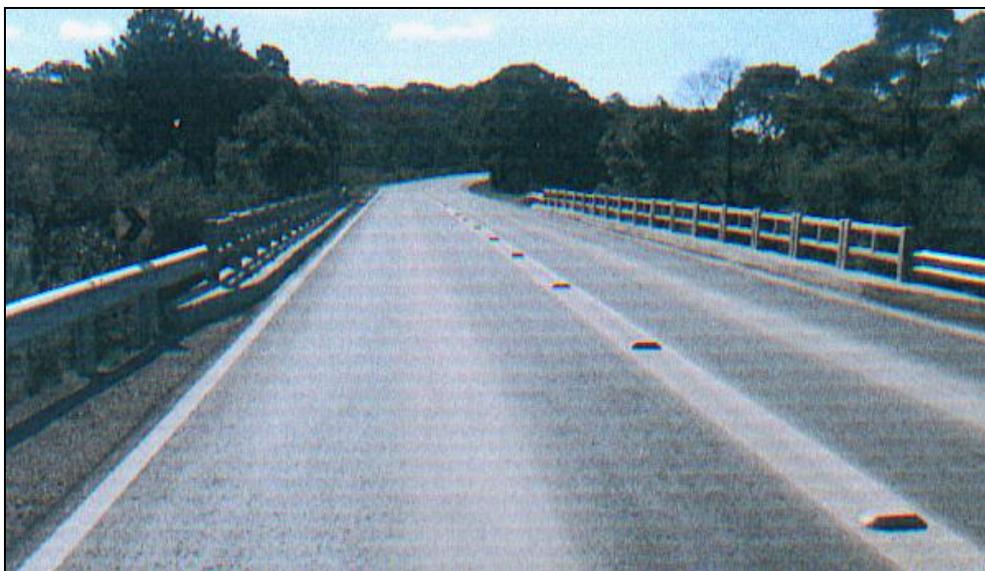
Detalhe da ponte com guarda corpo reconstruído, com defensas e sinalização executado (depois).
